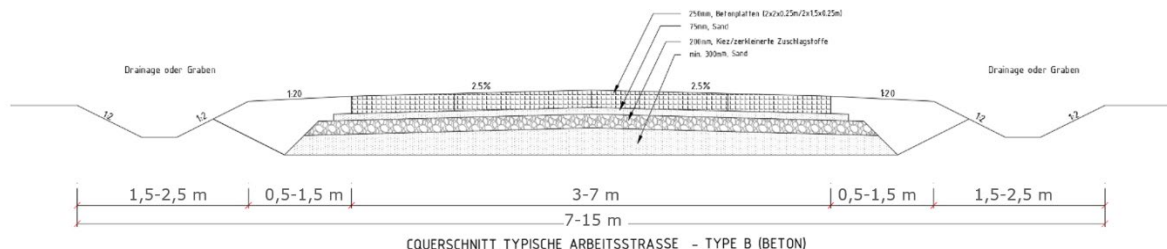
Querschnitt typische Baustraße Typ B (Beton)
